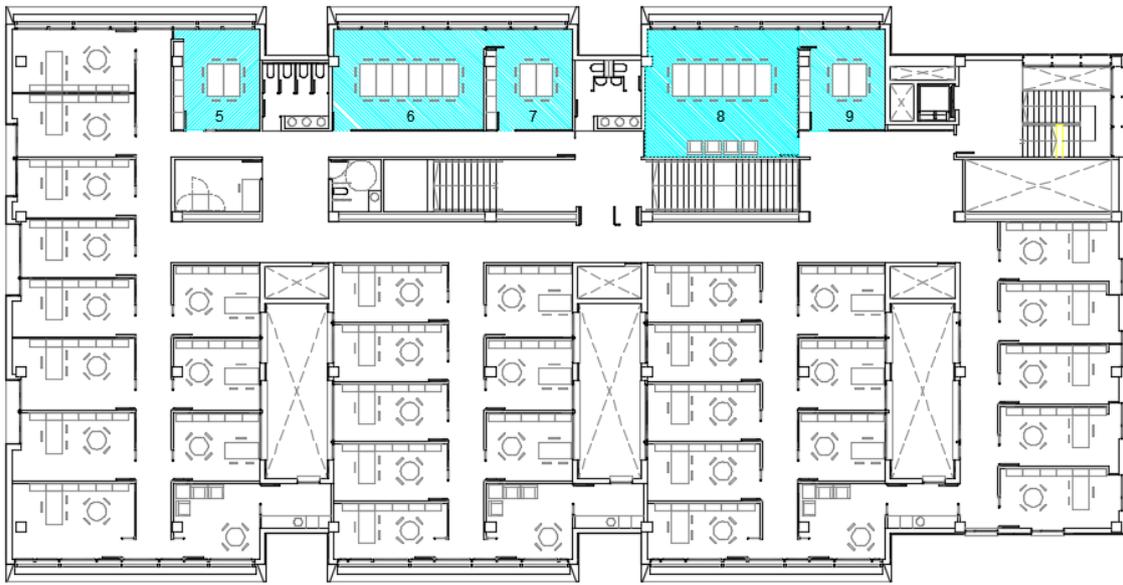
Situación Salas de Reuniones/Tutorías Planta Segunda. Figura extraída del plano 54.
